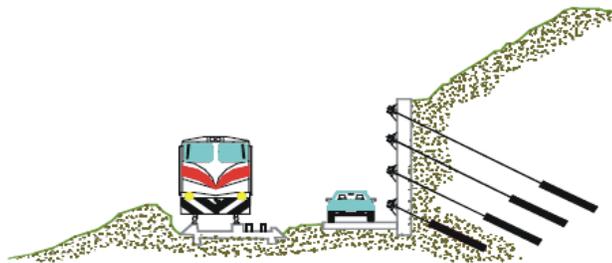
Muro anclado para estabilizar el talud en una carretera.
